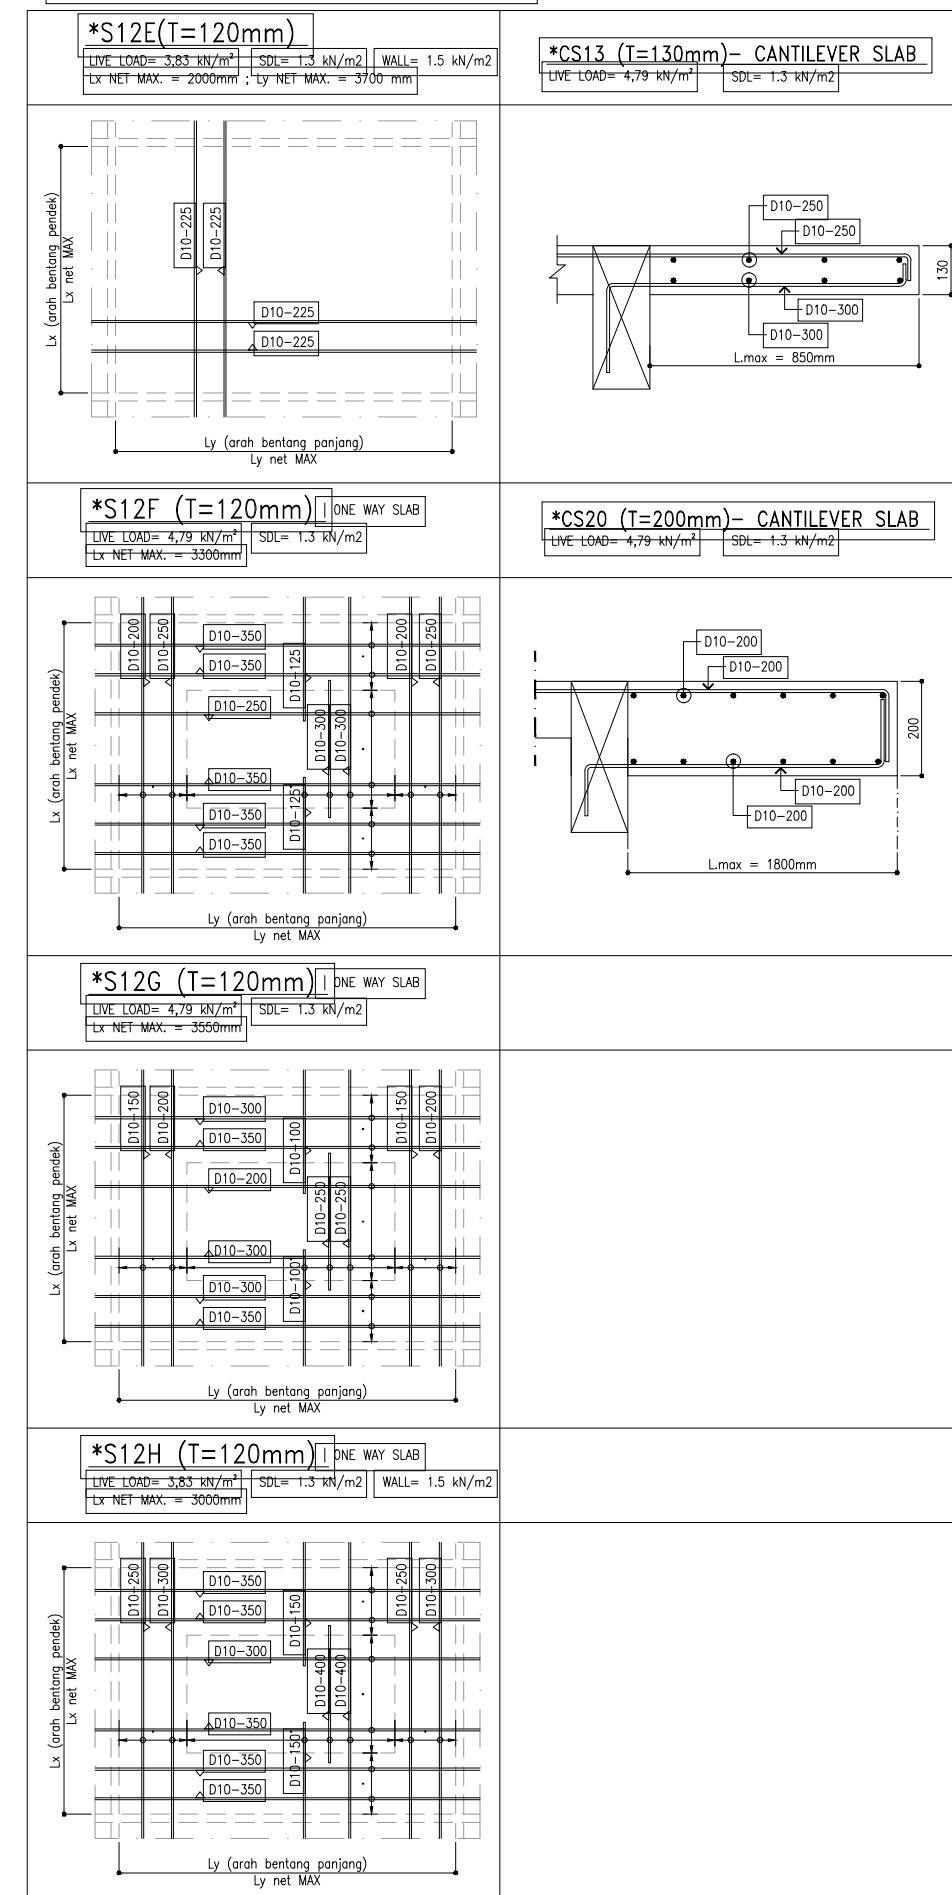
DETAIL PEMBESIAN SLAB LT.TYPICAL OFFICE
